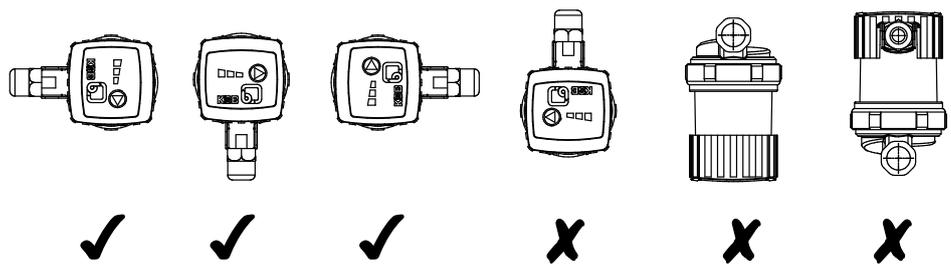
Posiciones de montaje permitidas de Calio-Therm S NC
